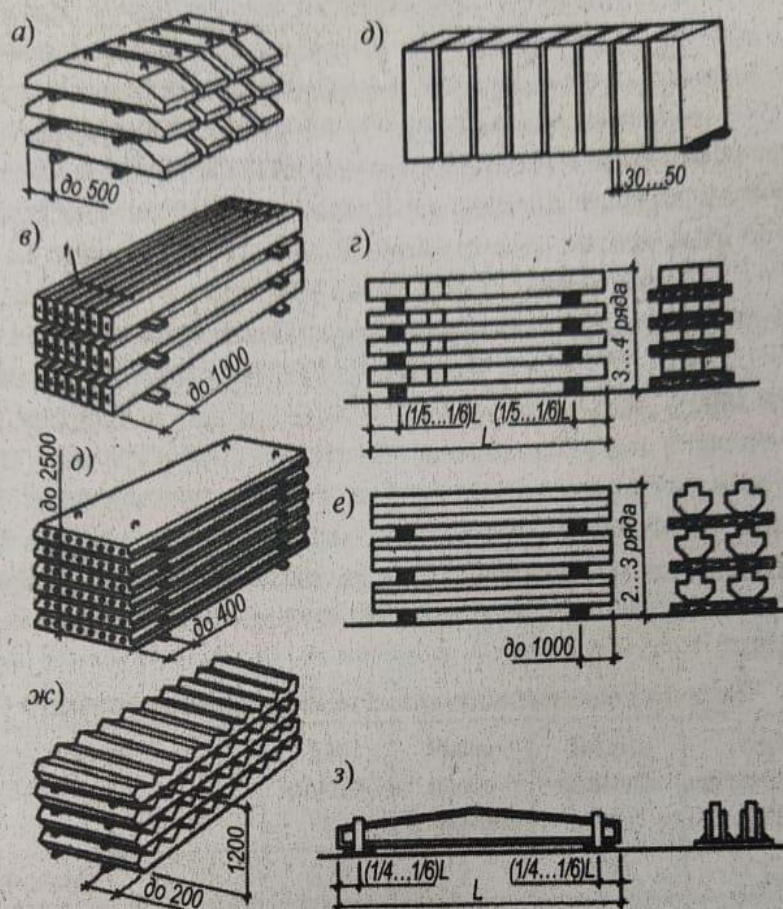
Складирование сборных железобетонных конструкций: а — фундаментные подушки; б — бетонные блоки; в — прямоугольные ригели, прогоны и перемычки; г — колонны; д — плиты перекрытий; е — ригели; ж — лестничные марши; з — балки; 1 — скрутка
